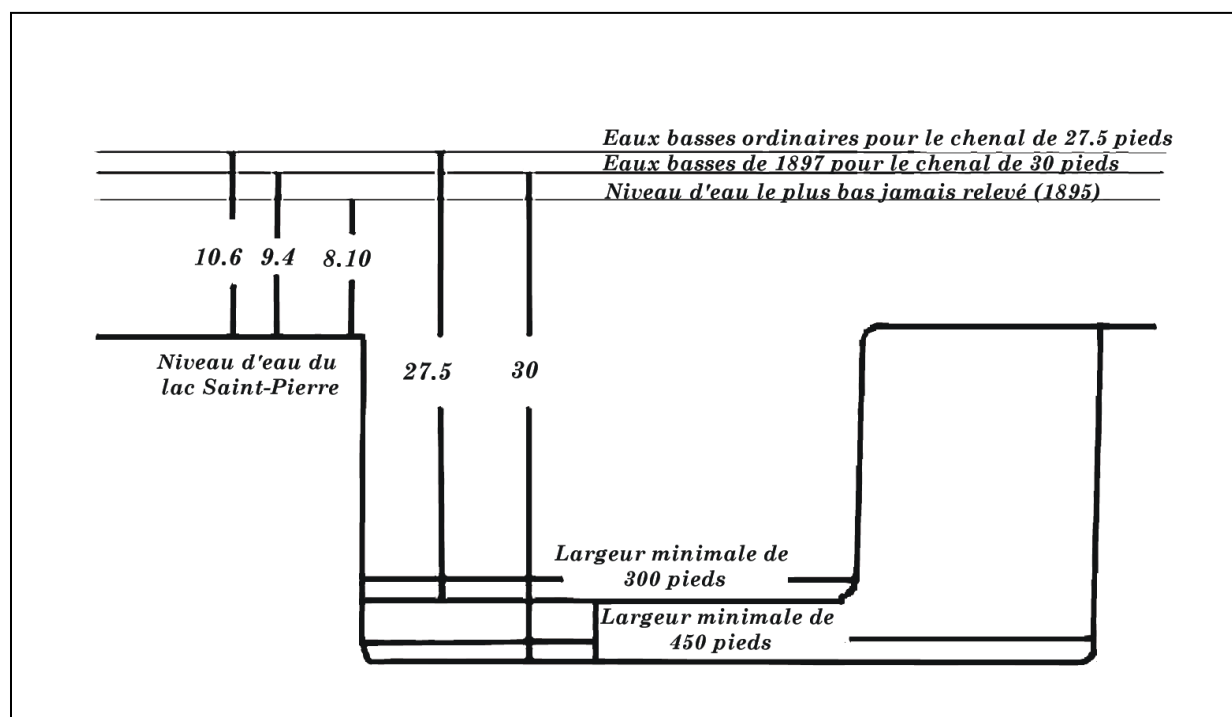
Plan montrant les dimensions comparatives des chenaux de 27,5 pieds (8,4 m) et de 30 pieds (9,1 m) (Robinson, 1902)
